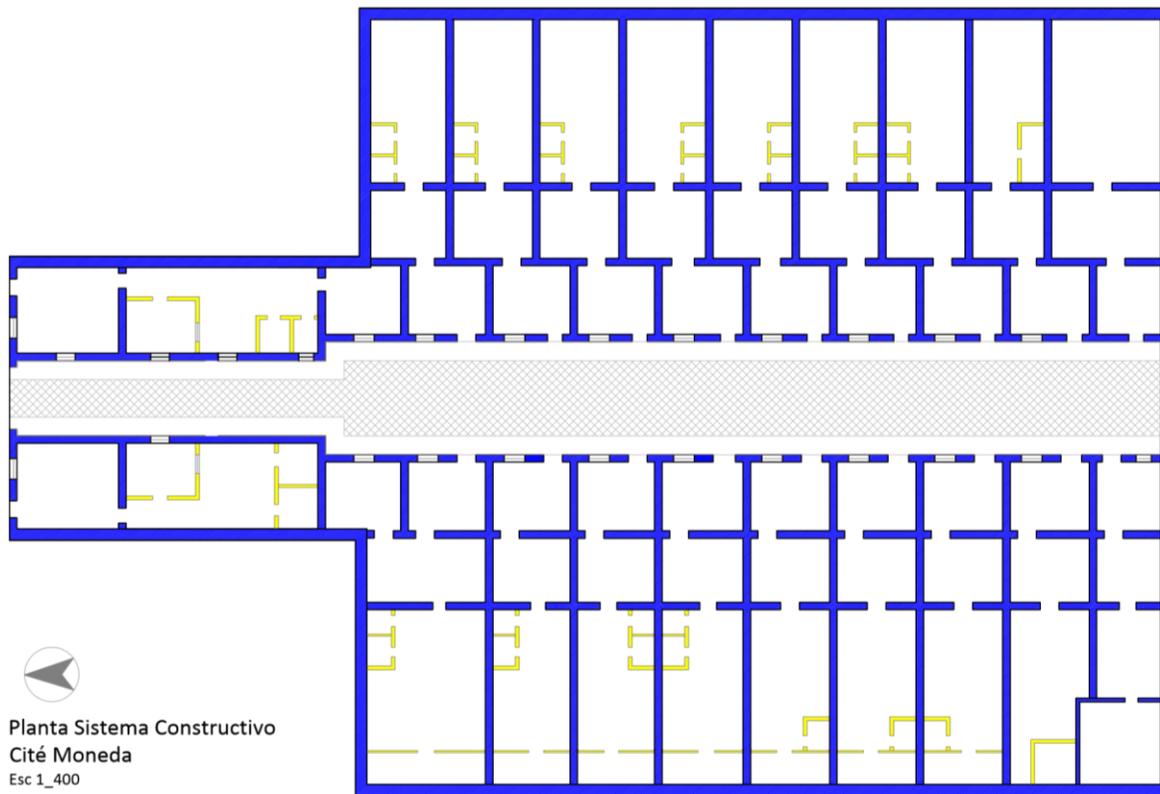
Planta Sistema Constructivo AZUL: Adobe\_ AMARILLO: Tabiquería
